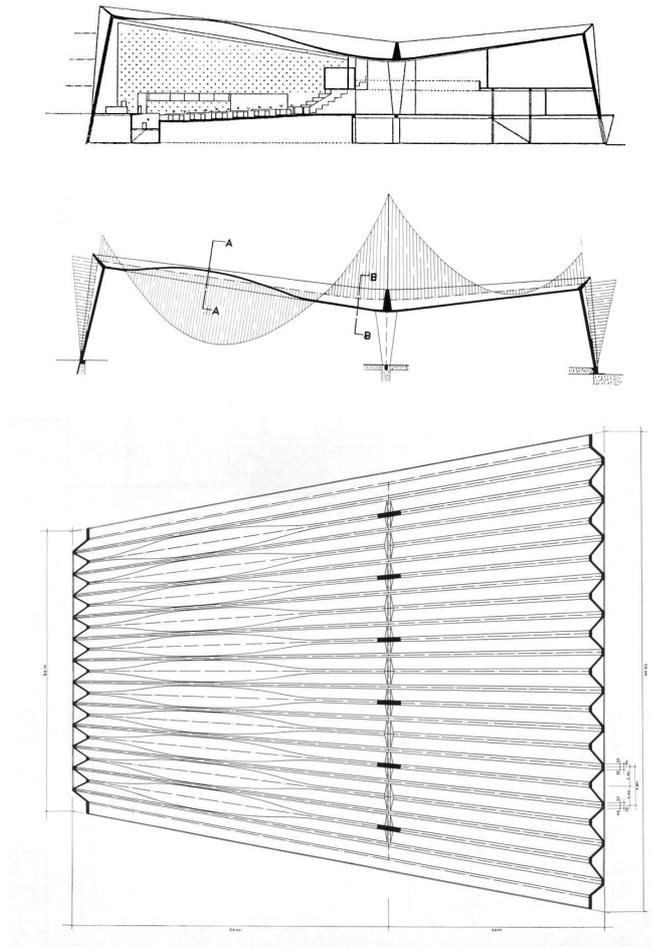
Sección, esquema estructural y planta de cubiertas de la Sede de la UNESCO de París, 1953-58. Pier Luigi Nervi, Marcel Breuer y Bernard Zehrffuss.
